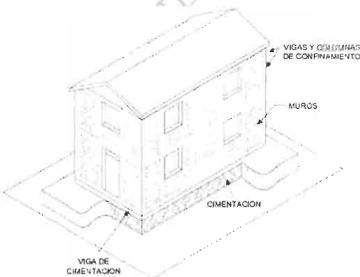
Elementos estructurales de una vivienda confinada
